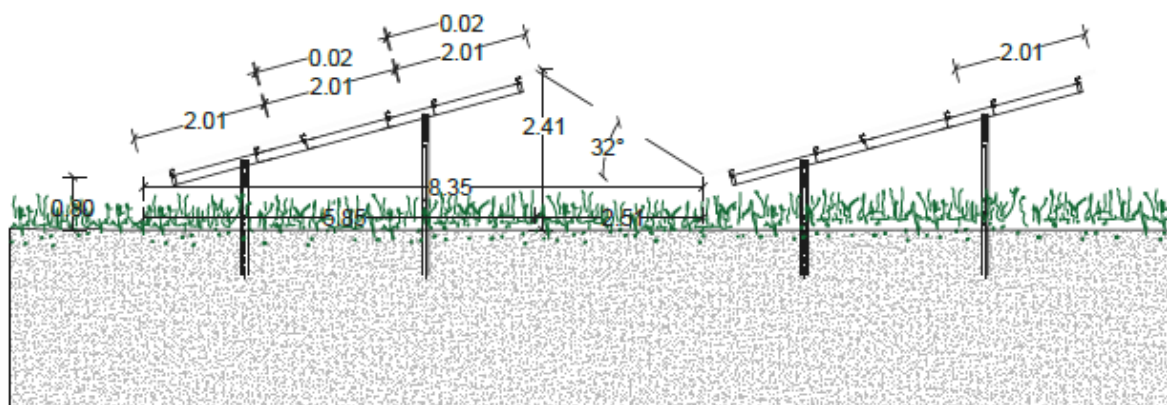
Vista in sezione delle strutture di supporto dei moduli con quotatura
